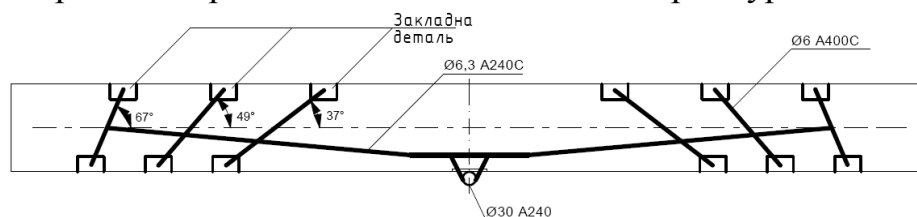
Схема підсилення балки БПС-ІІ-1 поздовжньою і поперечною похило розташованою зовнішньою арматурою
